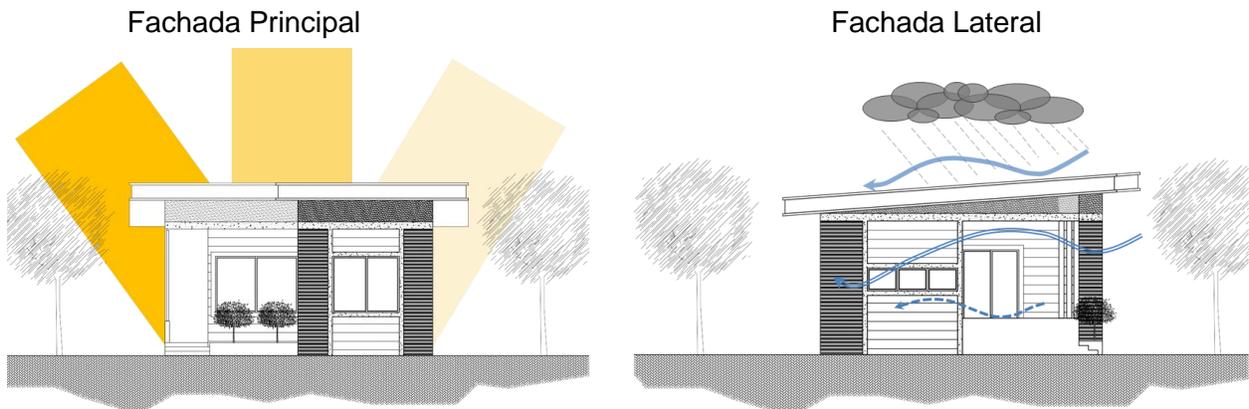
Fachadas Propuesta Vivienda 36m<sup>2</sup>, Fuente: Elaboración propia.
